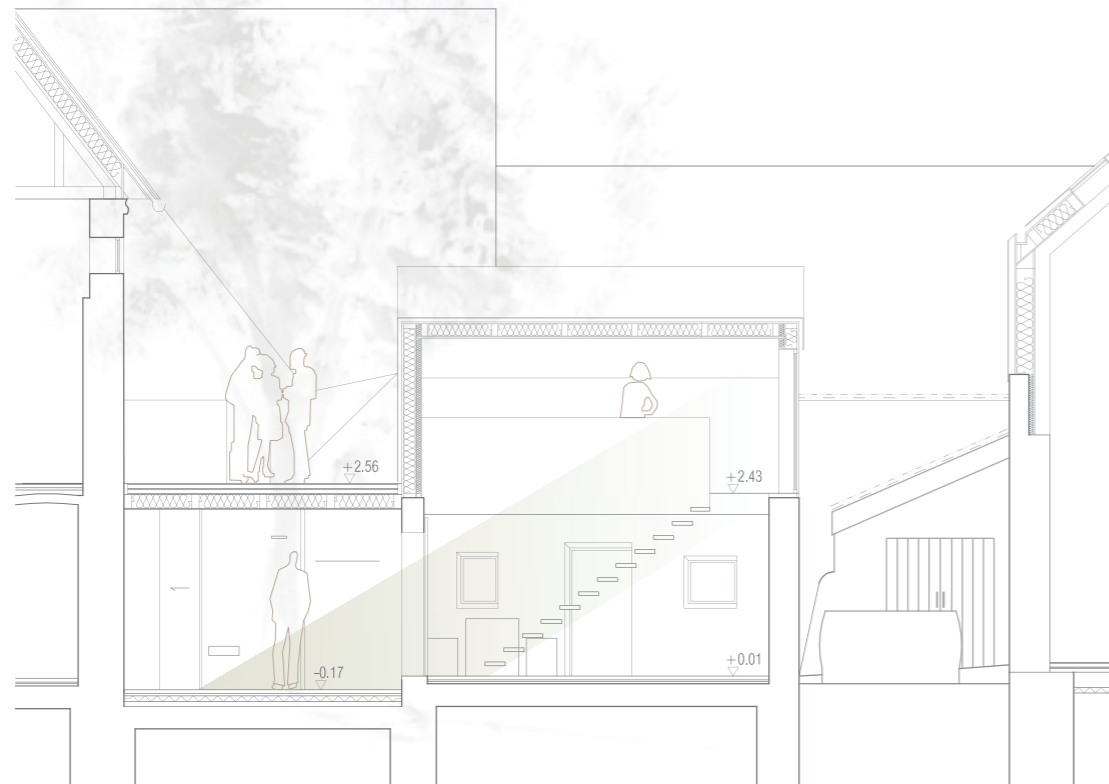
Gebäude B_GÄSTEHAUS_Schnitt CC Maßstab 1:100
